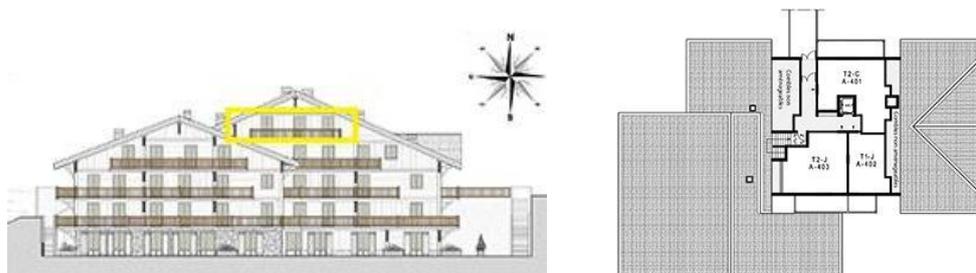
les plans 3eme et 4eme étage du bâtiment A
